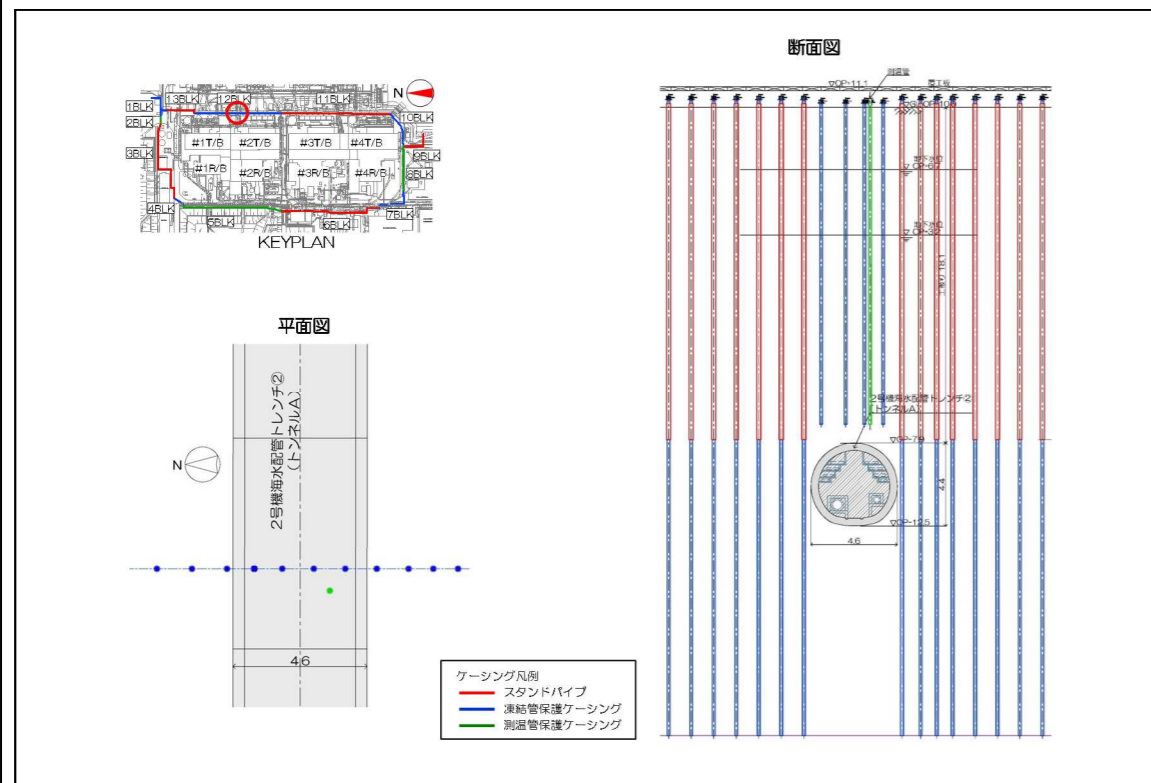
2号機海水配管トレンチトンネルA部 施工平面図・断面図
